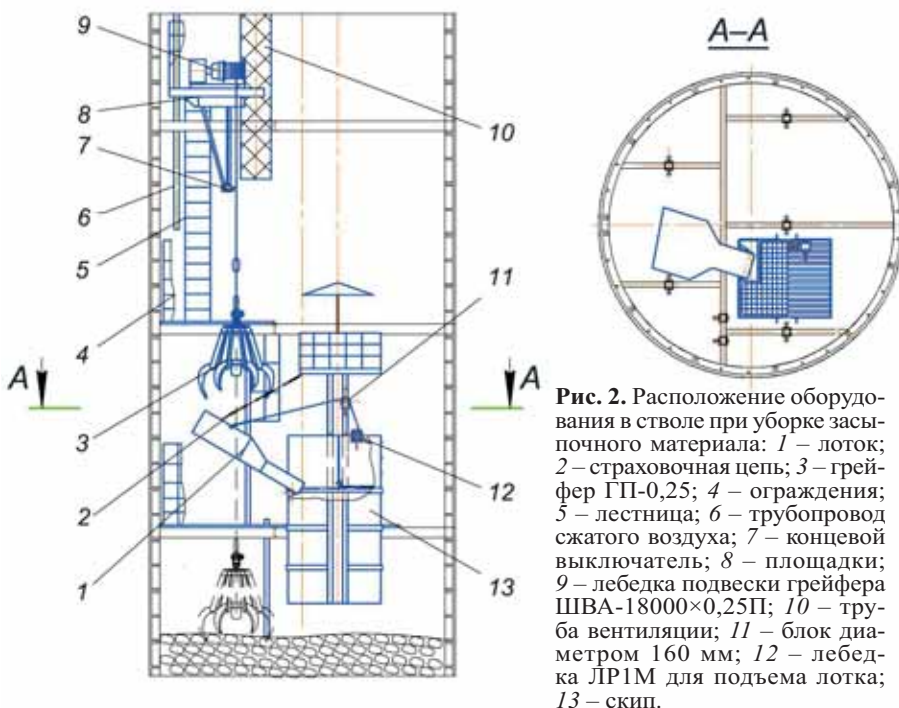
Расположение оборудования в стволе при уборке засыпного материала: 1 – лоток; 2 – страховочная цепь; 3 – грейфер ГП-0,25; 4 – ограждения; 5 – лестница; 6 – трубопровод сжатого воздуха; 7 – концевой выключатель; 8 – площадки; 9 – лебедка подвески грейфера ШВА-18000×0,25П; 10 – труба вентиляции; 11 – блок диаметром 160 мм; 12 – лебедка ЛР1М для подъема лотка; 13 – скип.
